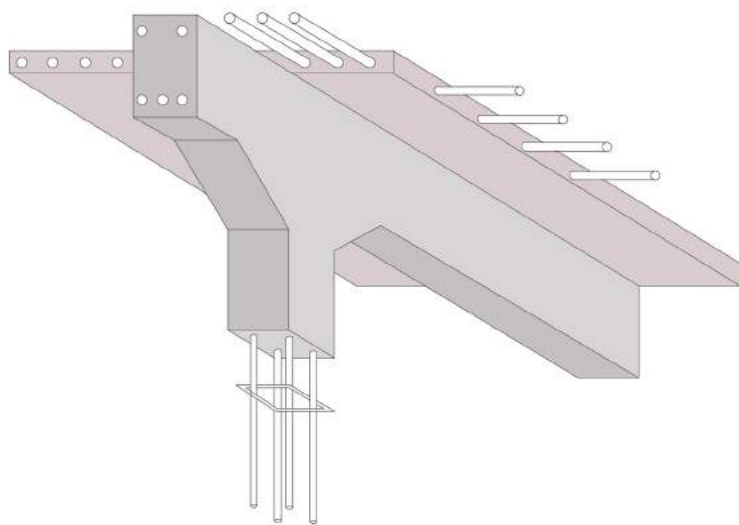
Sección constructiva y detalle en axonométrica del sistema constructivo de Bauhaus, Walter Gropius. Elaboración propia.
